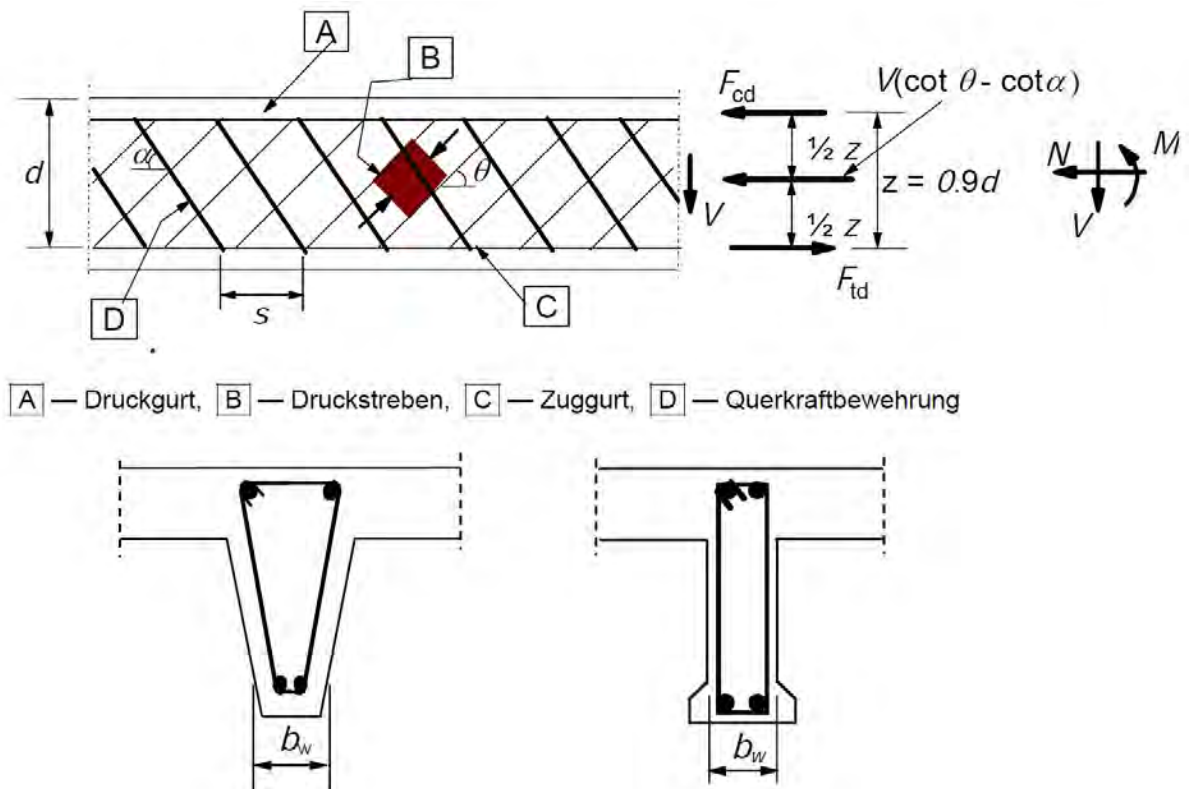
Fachwerkmodell und Formelzeichen für Bauteile mit Querkraftbewehrung [4]
